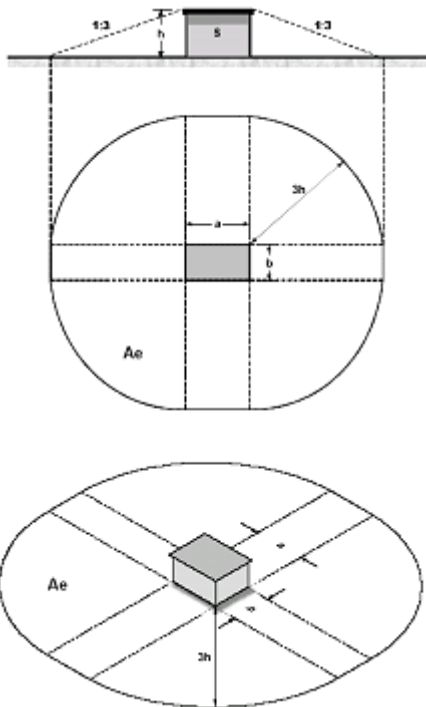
Área de captura equivalente para una estructura con techo plano y terreno plano.
